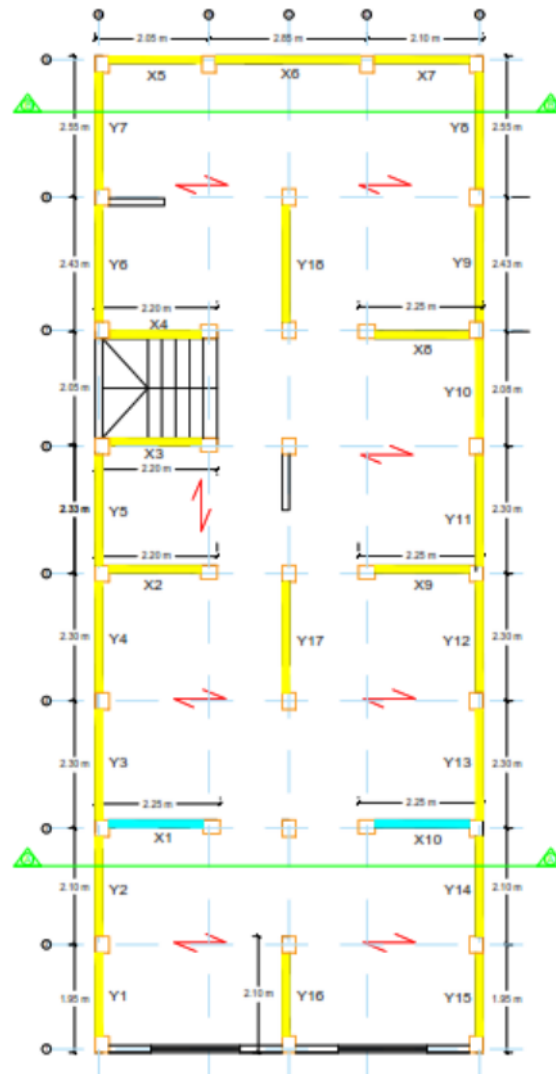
Planta de 1° nivel con muros reforzados en dirección X-X
